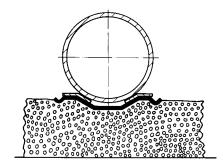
Alignement avec un profil en palplanches voir tableau ci-dessous
